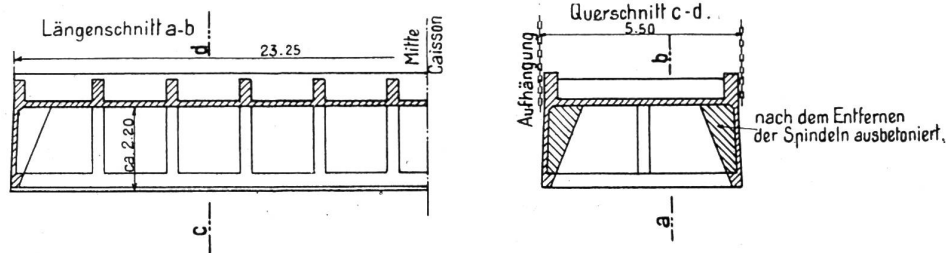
Rippencaisson aus Eisenbeton (schematisch)
